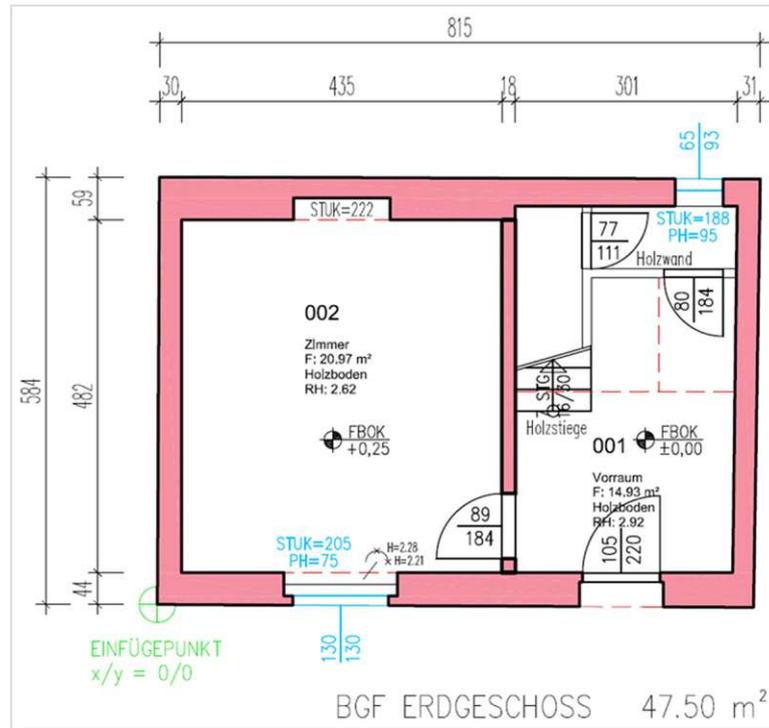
Grundriss Erdgeschoß Bestandsaufnahme, 2017 (Infratech GmbH)
